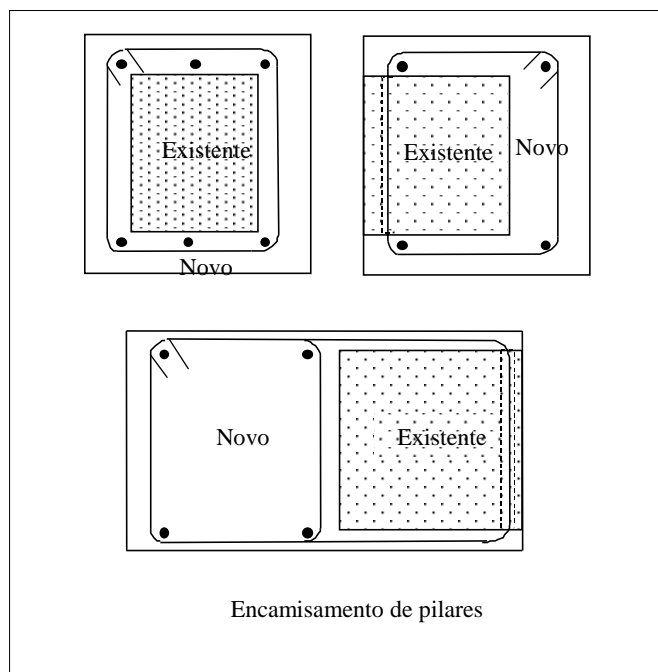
Reforço de pilares com encamisamento em betão [24].
